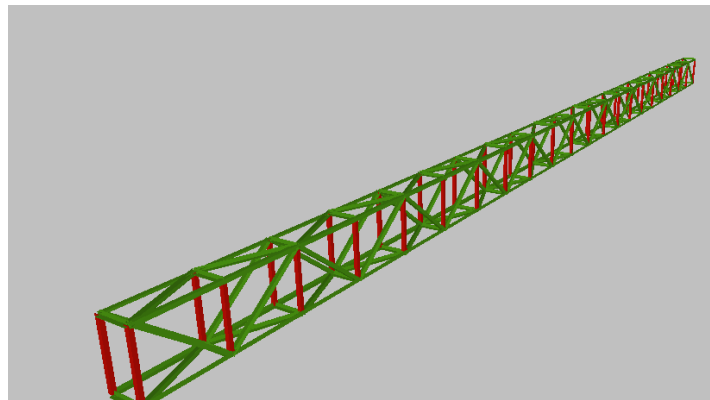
Vista 3D sección cercha para viaducto entre cámaras N8-N16 Y N106-N107
